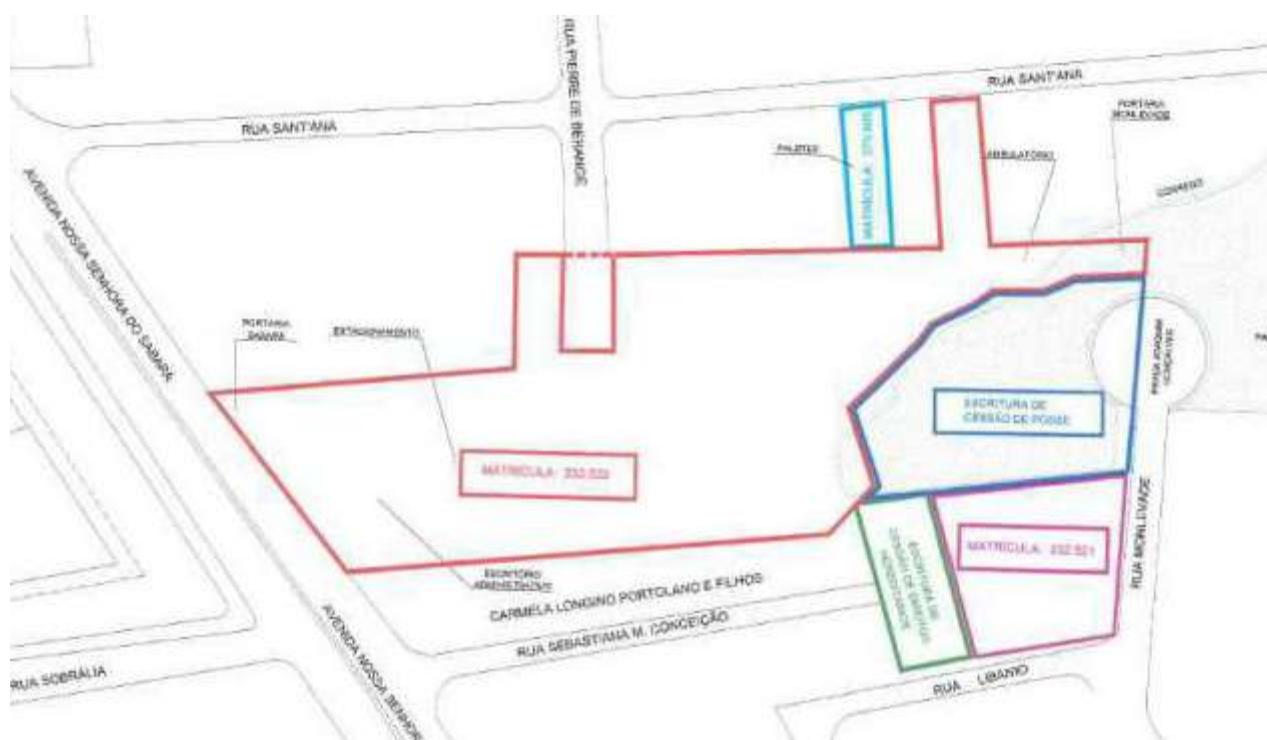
PLANTA DE ÁREAS DOS IMÓVEIS
